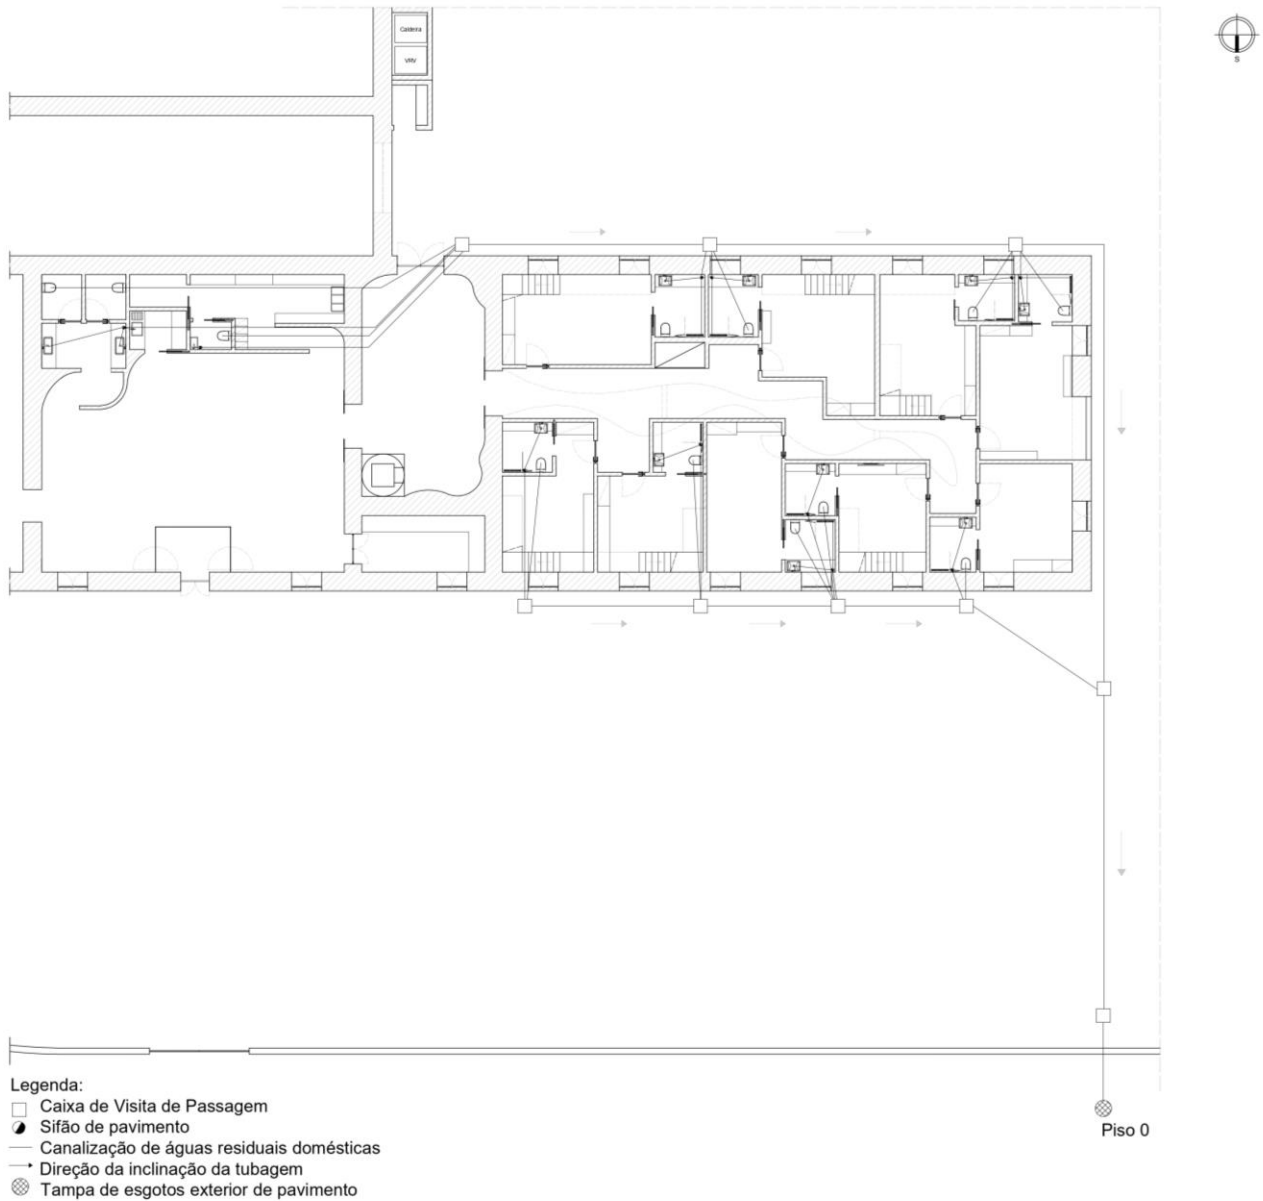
Planta de Esgotos, Piso 0, Alojamento Olive
